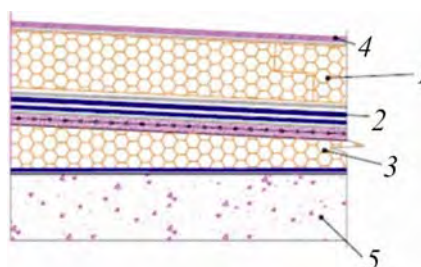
Крыша с двухслойным утеплителем: 1 — основной слой утеплителя; 2 — гидроизоляционный ковер; 3 — дополнительный слой утеплителя; 4 — фильтрующий материал; 5 — ребристая плита перекрытия
